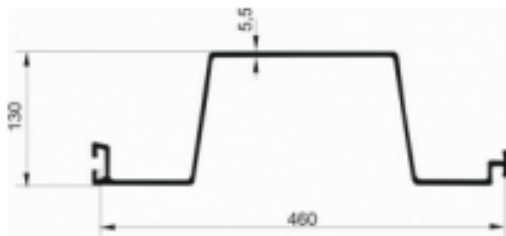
Diseño de plancha de PVC en mm. Catálogo de la empresa Plastic Piling Co.
